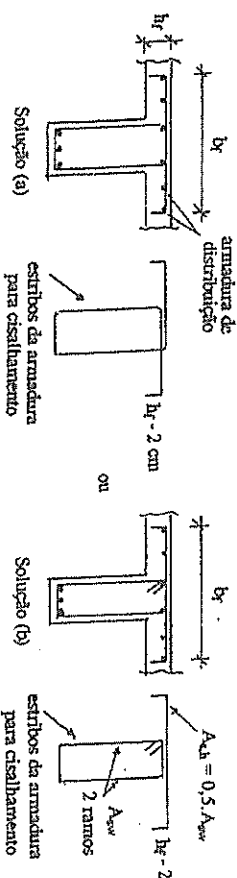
Armadura transversal na mesa de vigas com seção T
